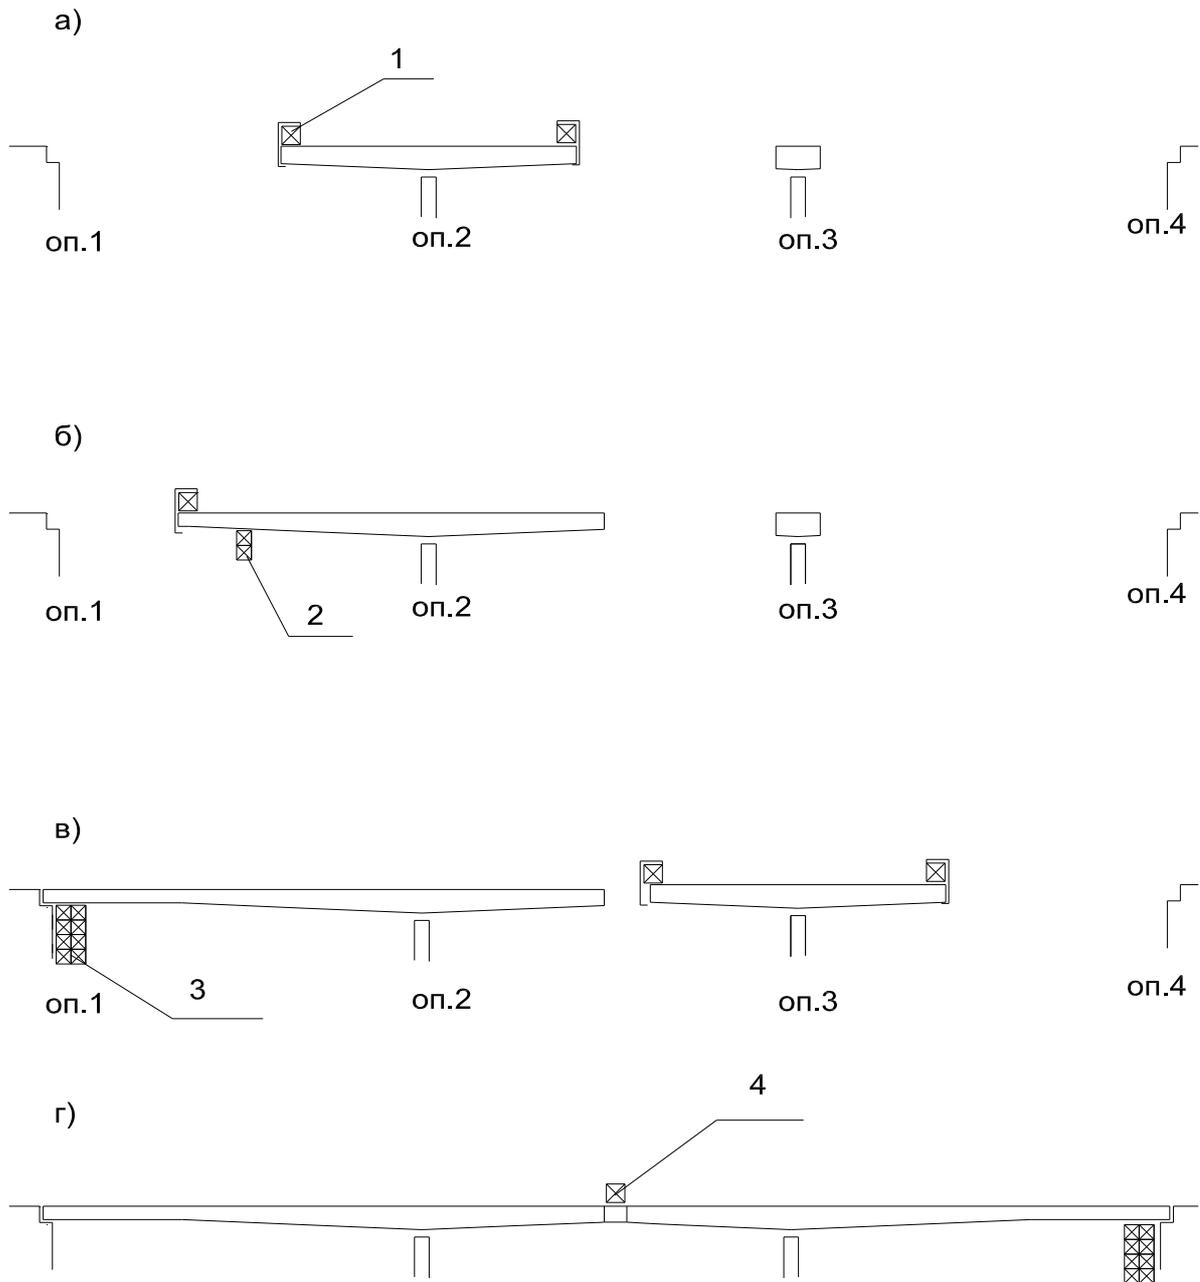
Навесное бетонирование трехпролетного неразрезного пролетного строения: а - уравновешенное навесное бетонирование левой "птички"; б - полууравновешенное навесное бетонирование левой "птички"; в - бетонирование конечного участка пролетного строения на подмостях, навесное бетонирование правой "птички"; г-бетонирование стыка между "птичками": 1-агрегат для навесного бетонирования консольного типа; 2 - временная опора; 3 - подмости; 4 - опалубка для бетонирования замыкающего участка пролетного строения
